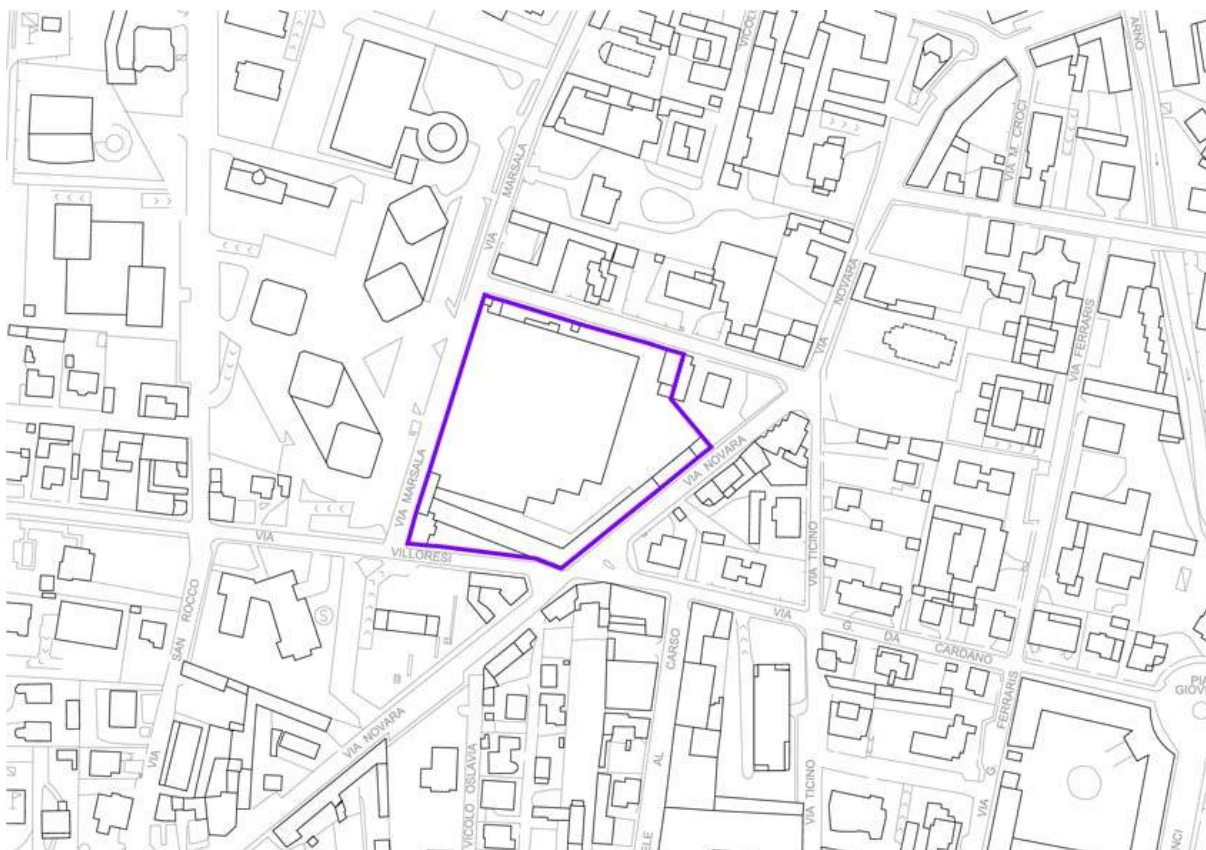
Planimetria della Tessitura Bassetti PRS4
